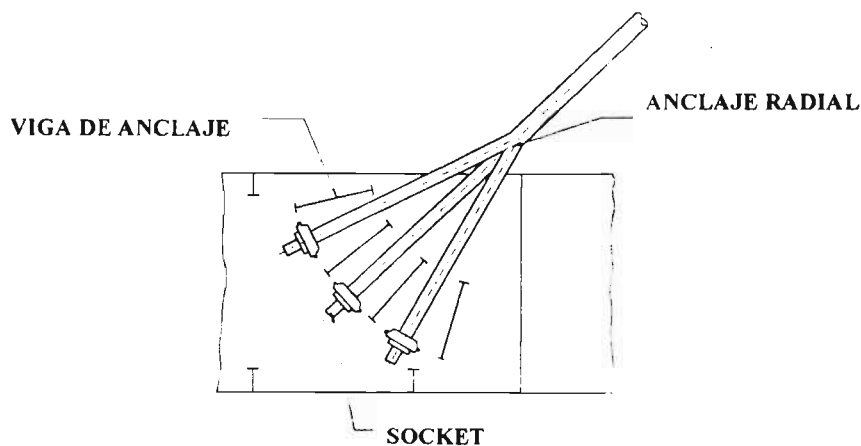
Esquema de la estructura del anclaje apoyo radial- viga de anclaje.
